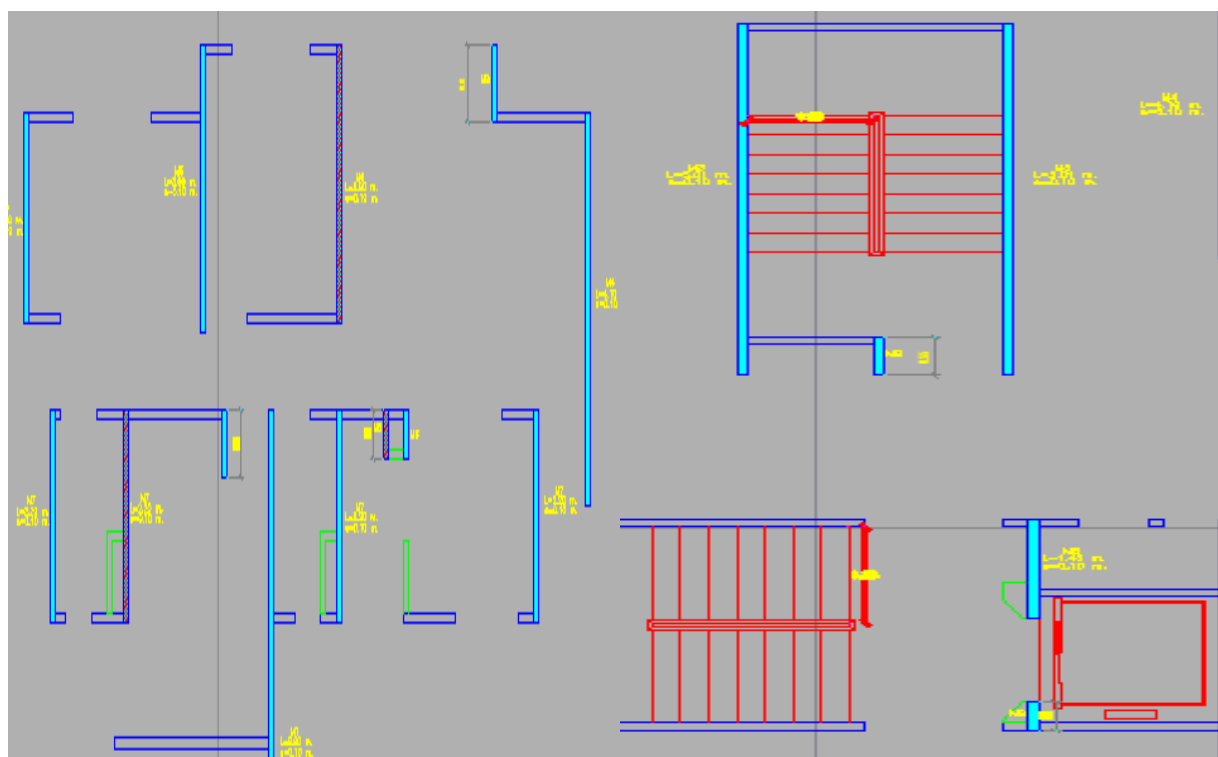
Dirección vertical. Fuente: Constructora Adriana Rivera
